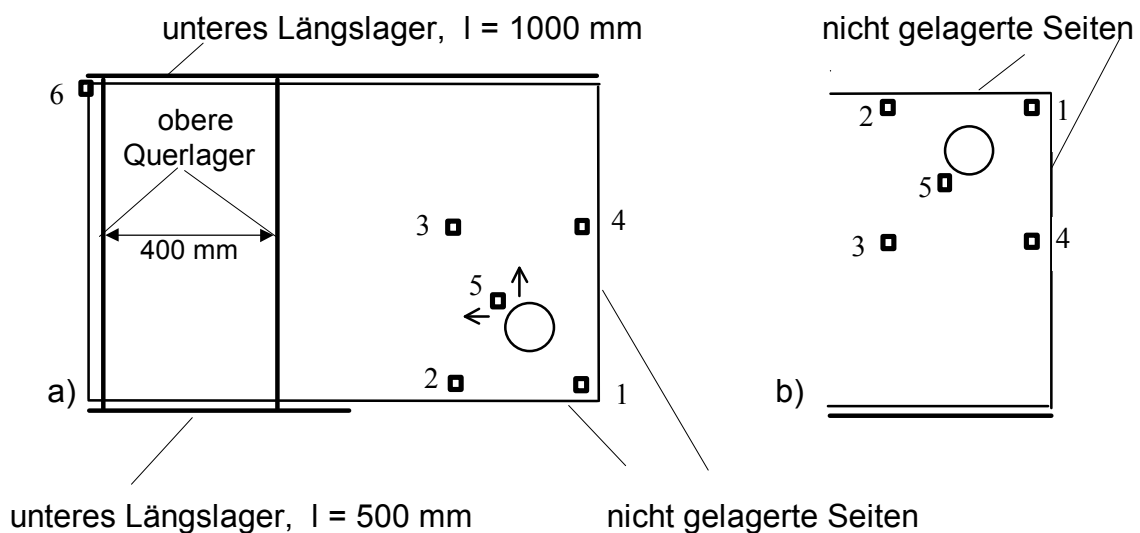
Plattengrundriss mit Lagerlinien und Wegaufnehmer
